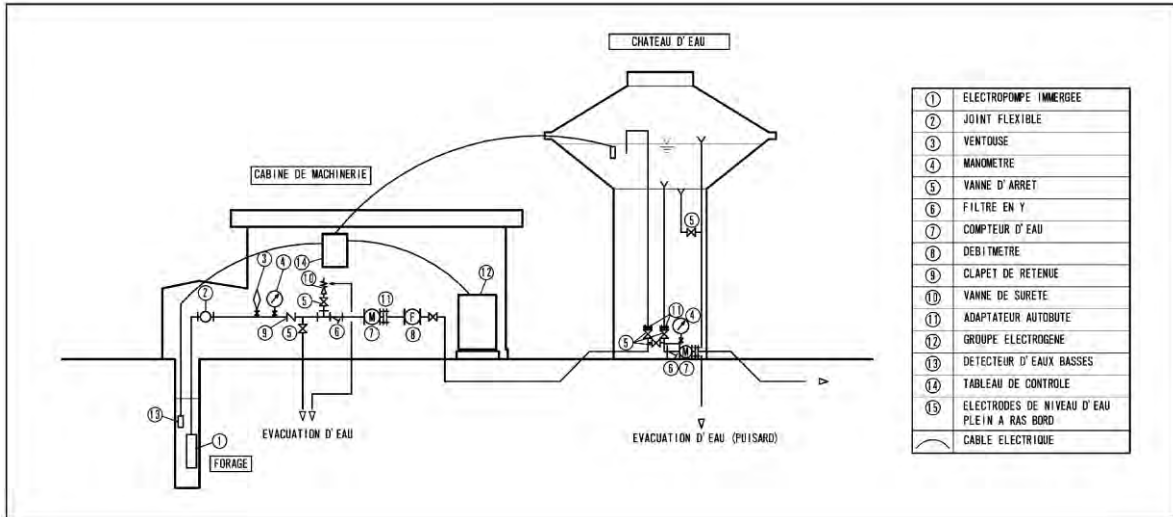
Plan du système d'adduction d'eau (du forage au château d'eau)
